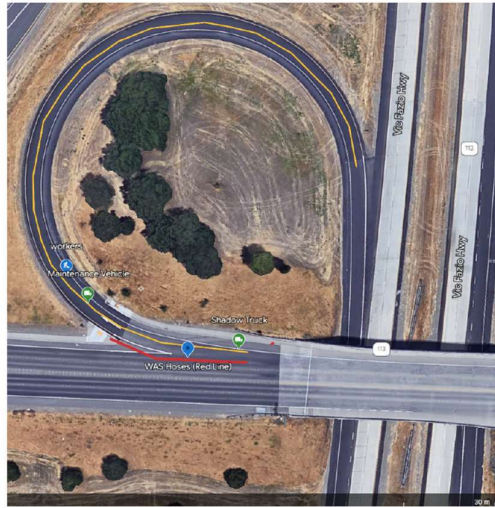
Installazione nell'area di cantiere del dispositivo WAS _ Sesta configurazione di cantiere
